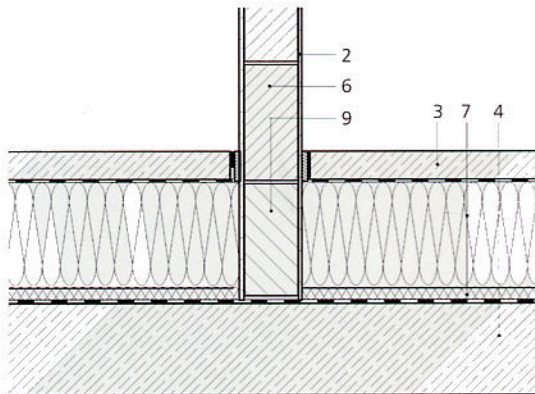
Détail de construction : coupe verticale de la liaison entre un plancher et une paroi intérieure
